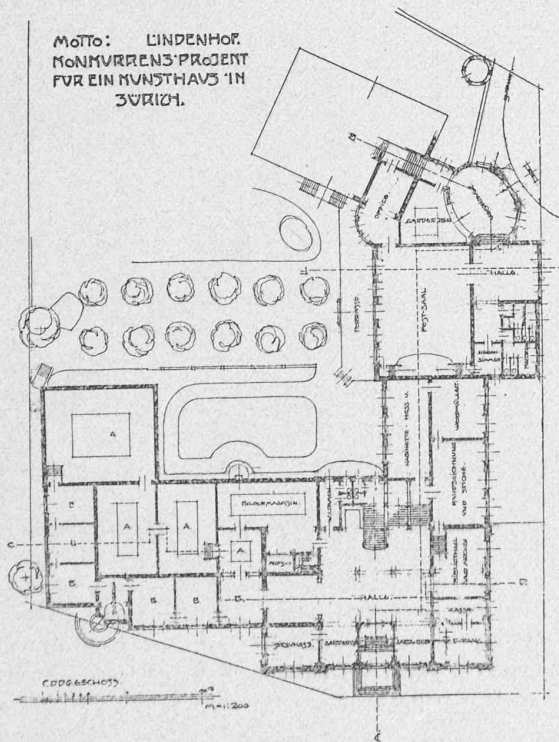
III^{me} Prix: Projet n° 9 « Lindenhof ». Plan du rez-de-chaussée.
